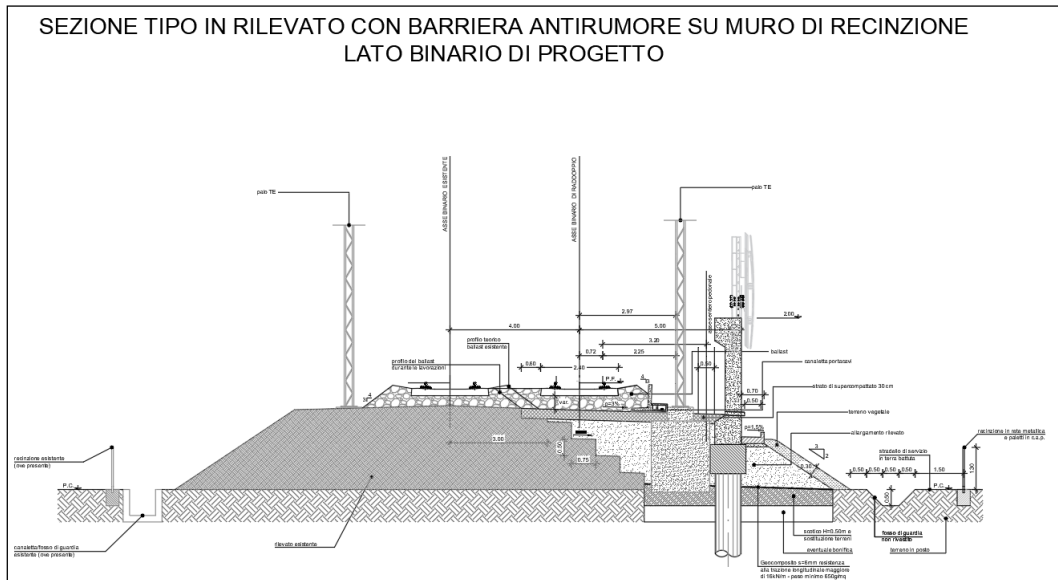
Sezione tipo in rilevato con barriera antirumore su muro di recinzione lato binario di progetto
